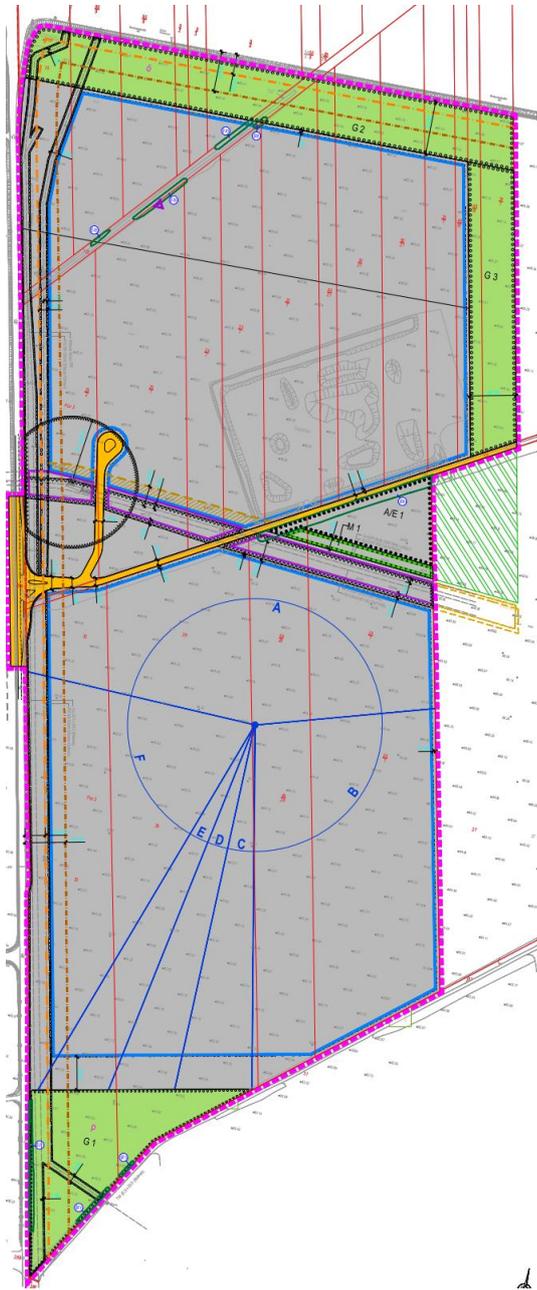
Planzeichnung Bebauungsplan Gewerbe- und Industriegebiet Salzfurkapelle
